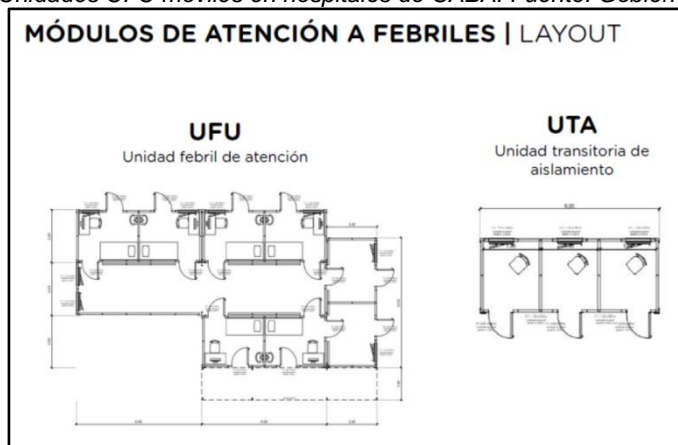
Plano de planta de unidades UFU. Fuente: Gobierno CABA
